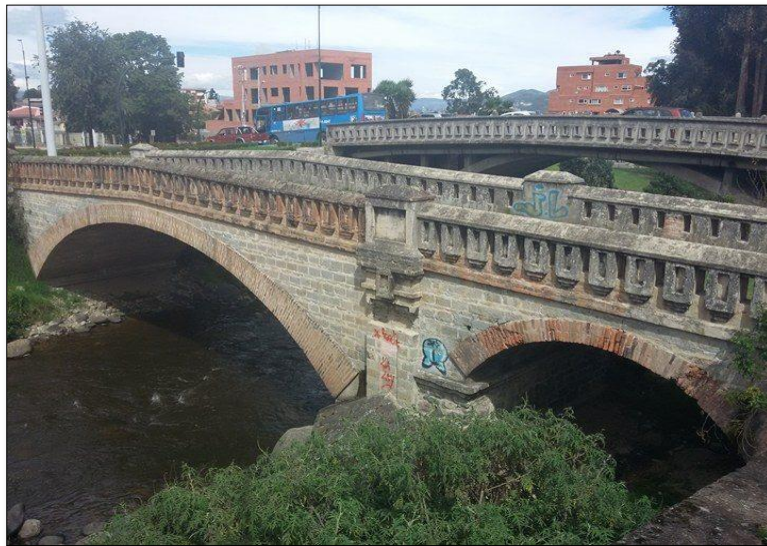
Puente de mampostería, tres puentes Cuenca. Elaborado por: Autor
